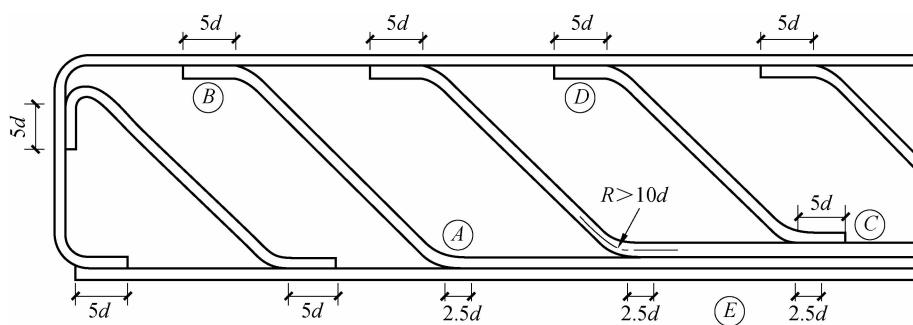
焊接钢筋骨架焊缝尺寸图
